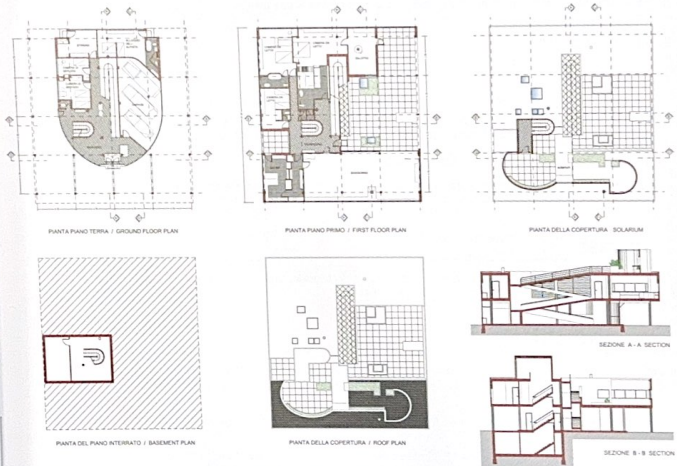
Villa Savoye: piante e sezione. Autore: Archweb.com
